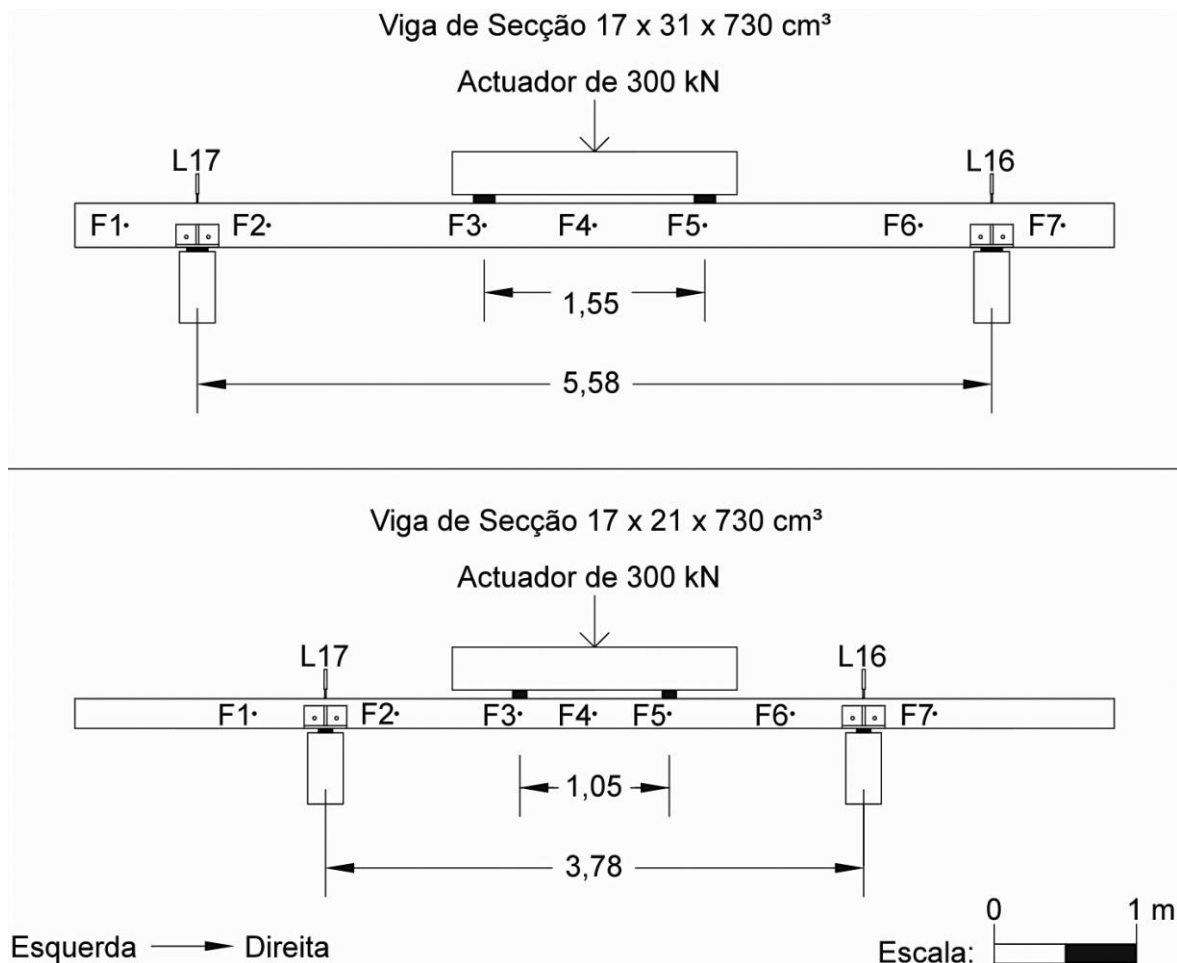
Esquema de ensaio e instrumentação das vigas de madeira
